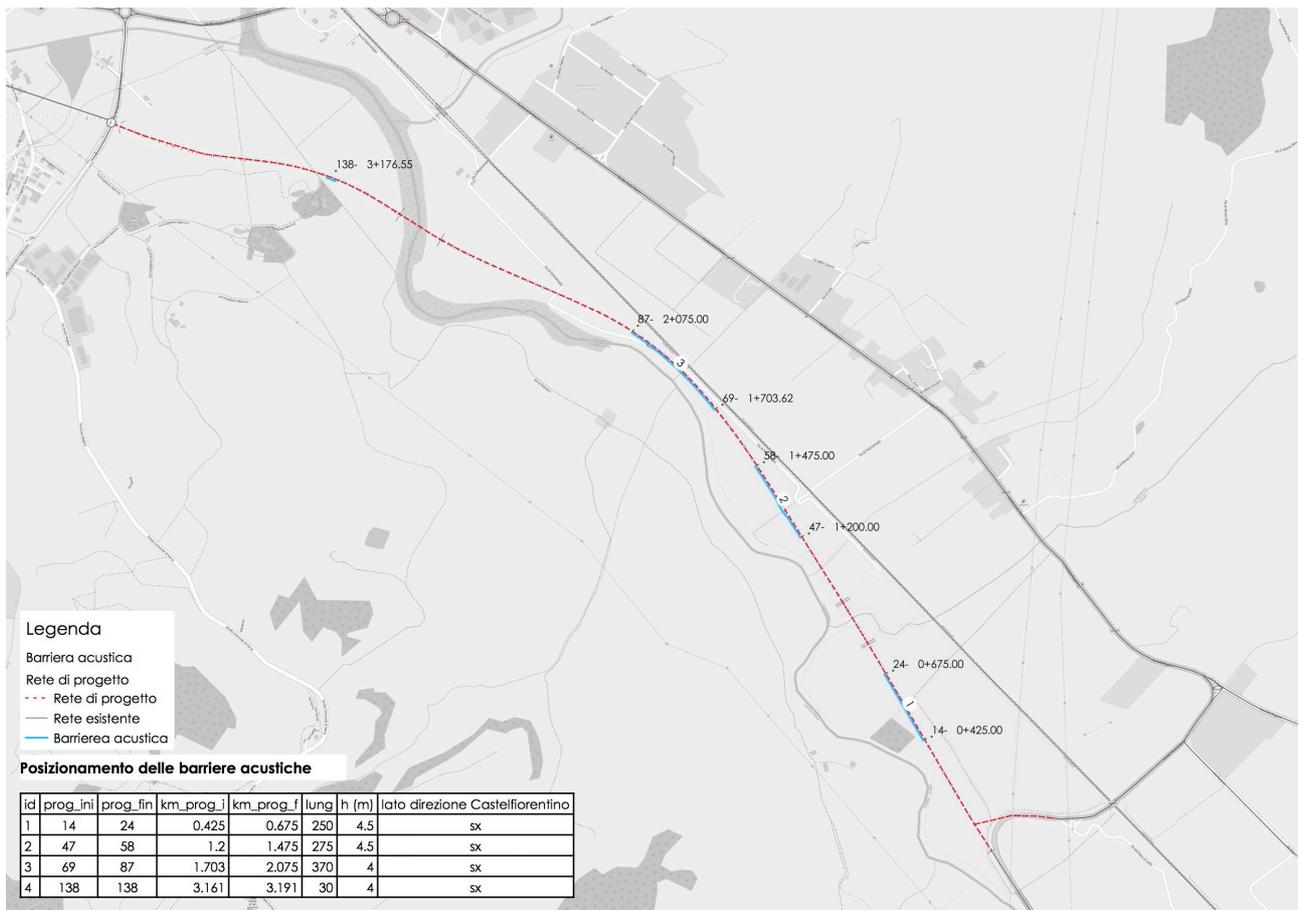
Planimetria del posizionamento delle barriere acustiche.
